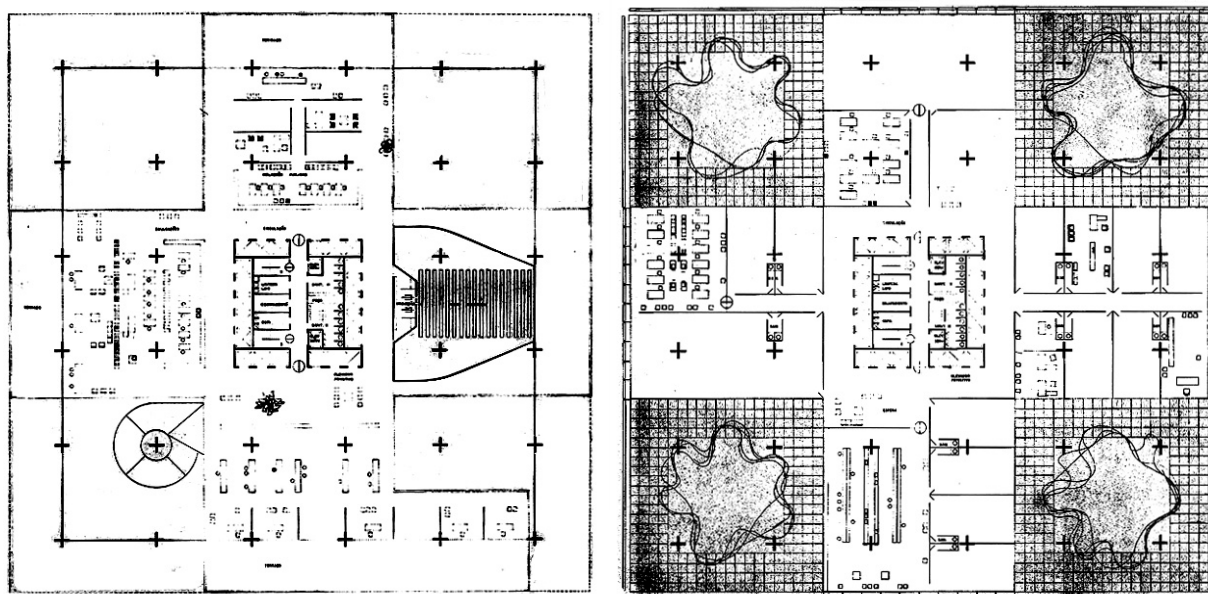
1º prêmio Edifício-sede da Petrobrás; planta 1º pavimento; auditório, exposições e biblioteca central.
